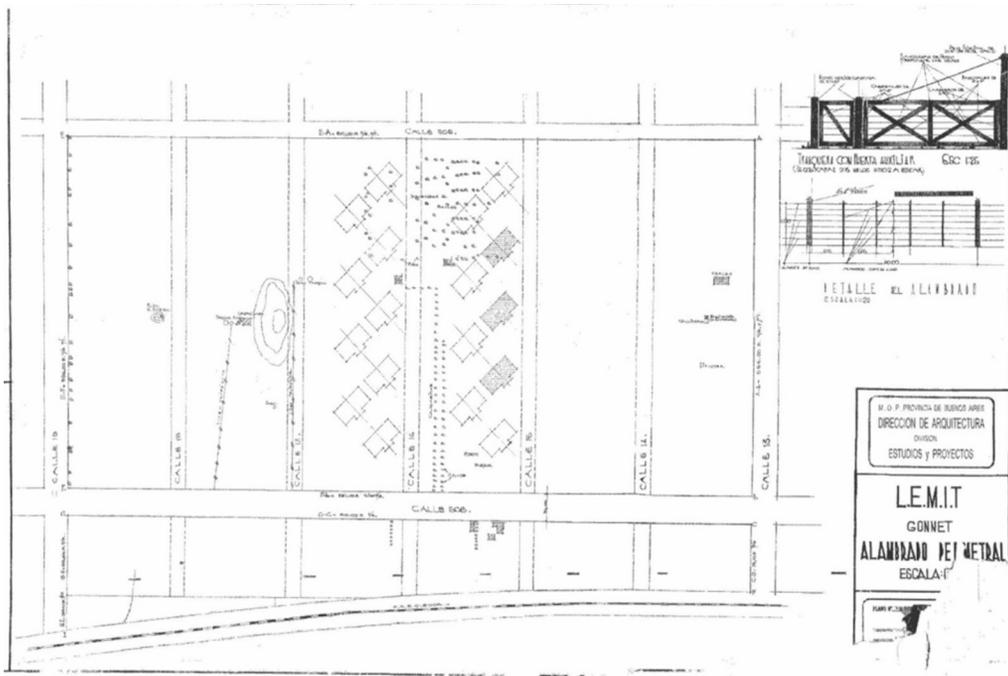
Plano del alambrado perimetral e implantación de los pabellones LEMIT [2].
